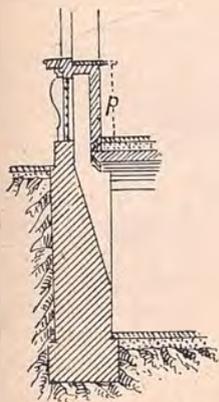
Finestra di cantina aperta nel parapetto della finestra del pianterreno.
